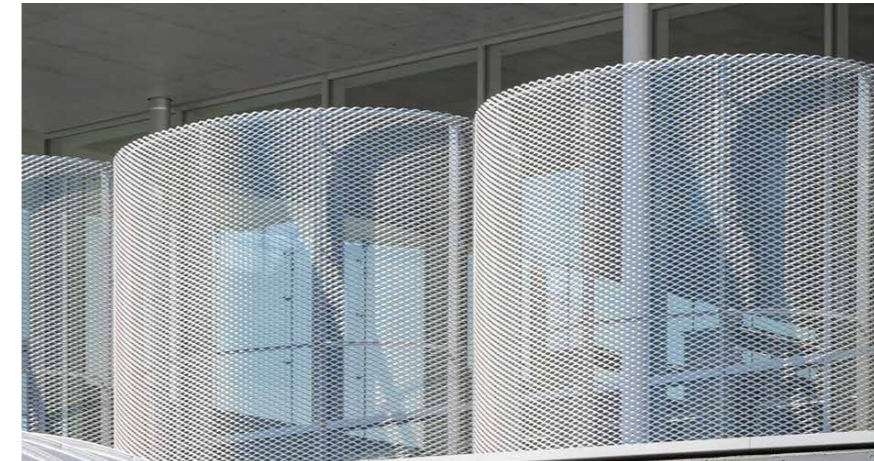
Pormenor das chapas metálicas na fachada norte. © Vincent Hecht
